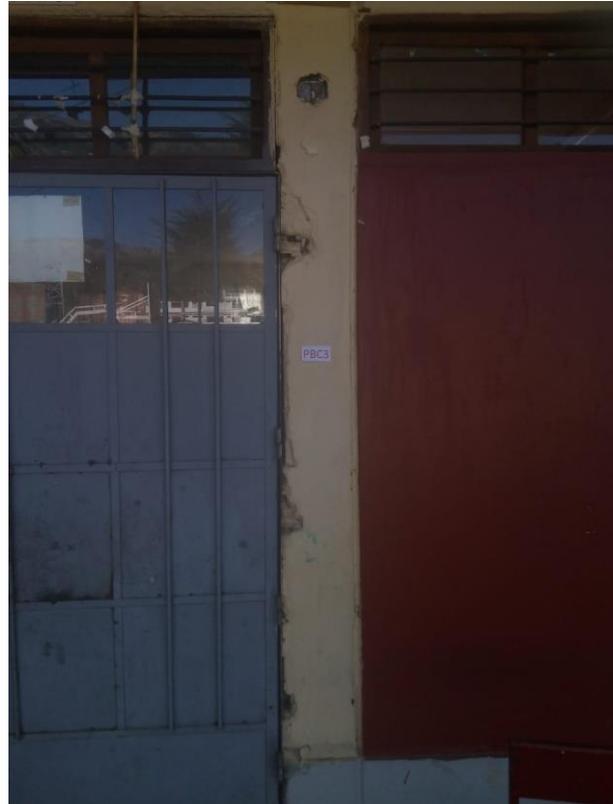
Grietas y fisuras en columna en el pabellón “B”
